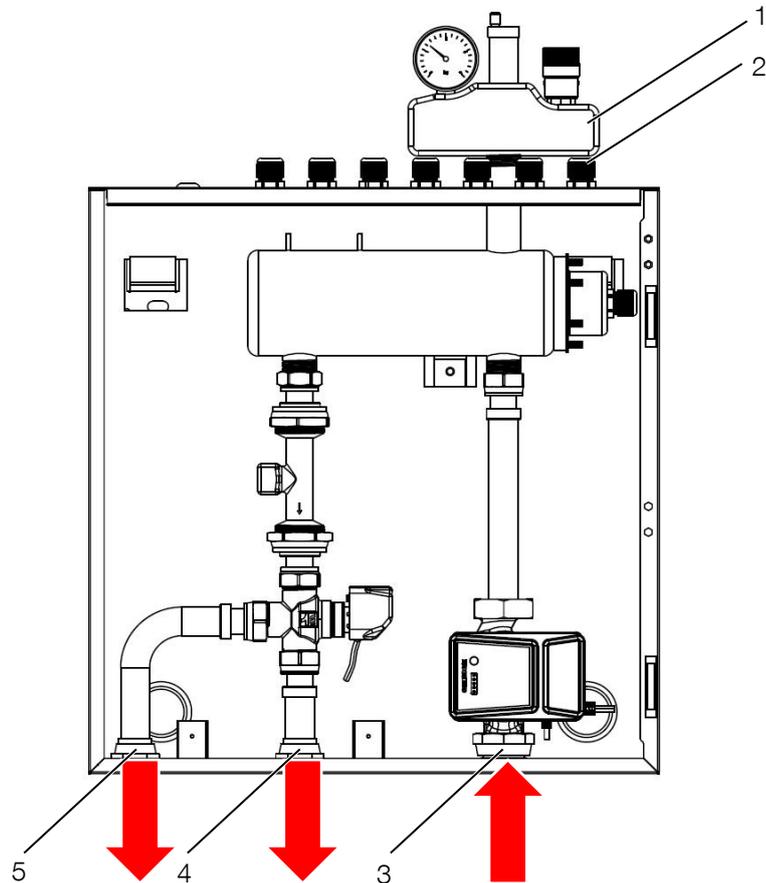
Anschlüsse Innengerät (MB700008 und MB700015)
